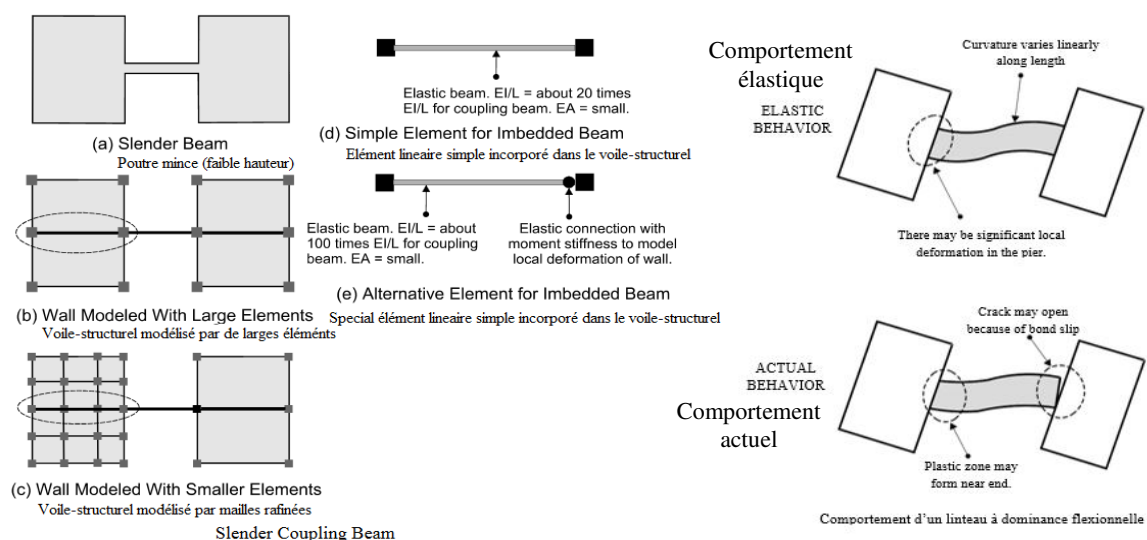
Poutres linteaux à dominance flexionnelle (poutres- minces (faibles-hauteurs) [53].
